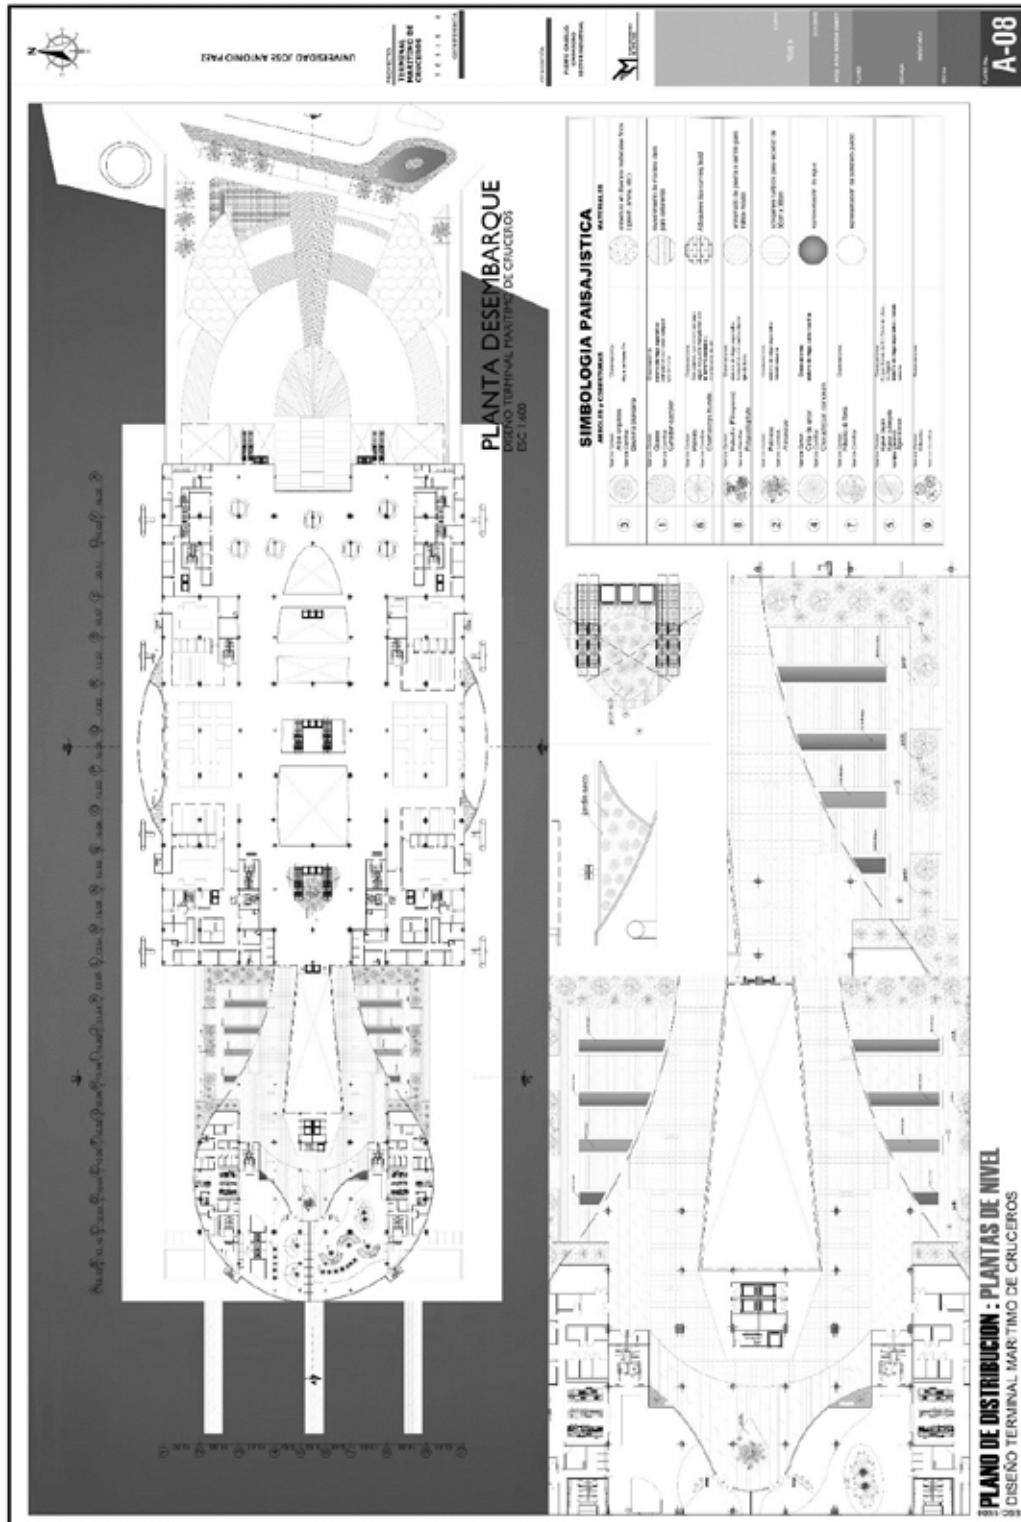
Plano de paisajismo de planta desembarque (Nivel +13.75)
